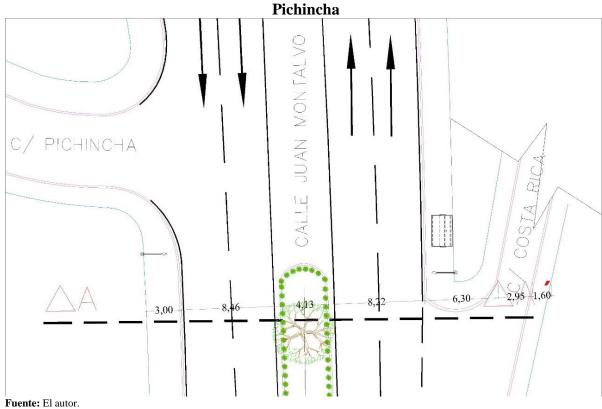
Vista en planta intersecciones de la calle Juan Montalvo y la Calle
